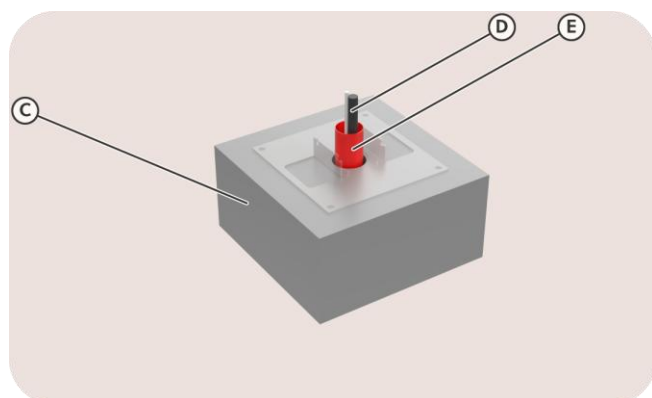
Exemple d'une fondation solide (C), avec des câbles (D) dans un système de conduits flexibles (E)
